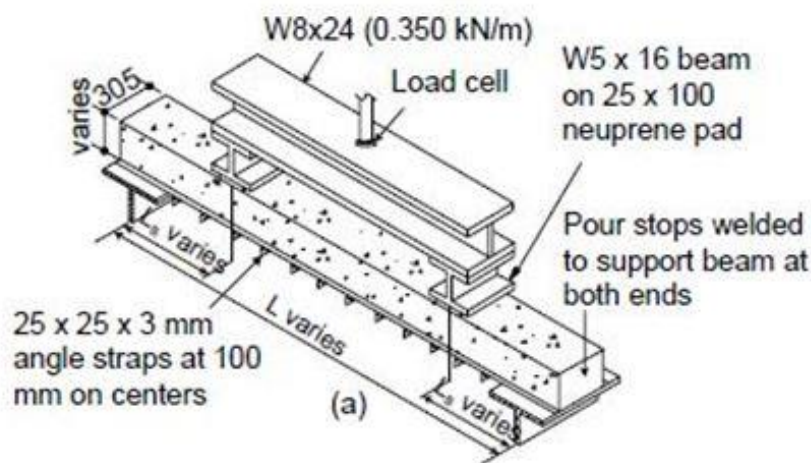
Ensaio de flexão em uma nervura de laje mista (adaptado [19])
